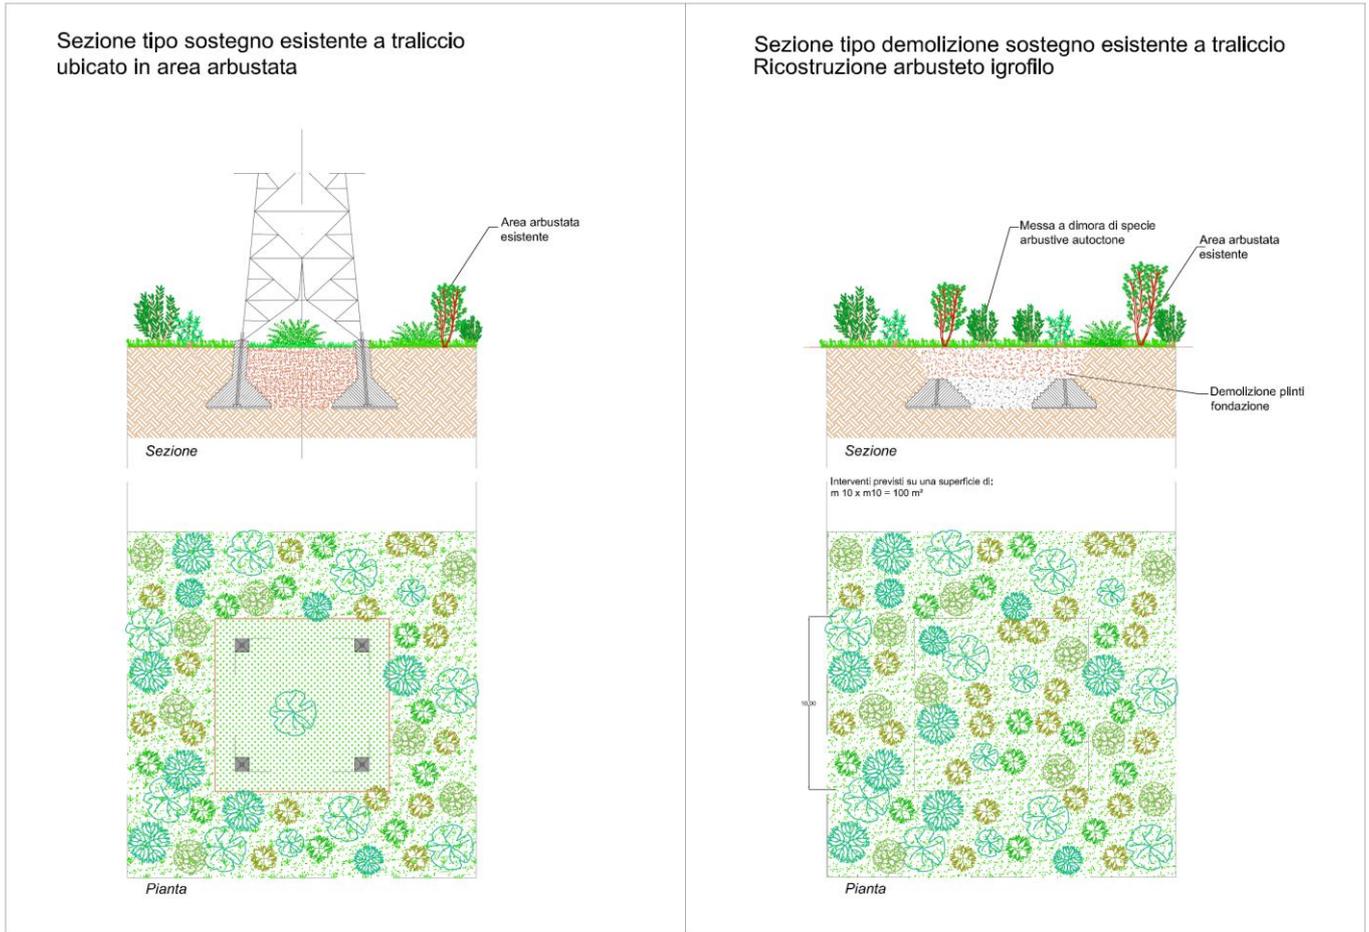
Sezione tipo e pianta Intervento Ricostruzione vegetazione mantello ad arbusteto igrofilo
